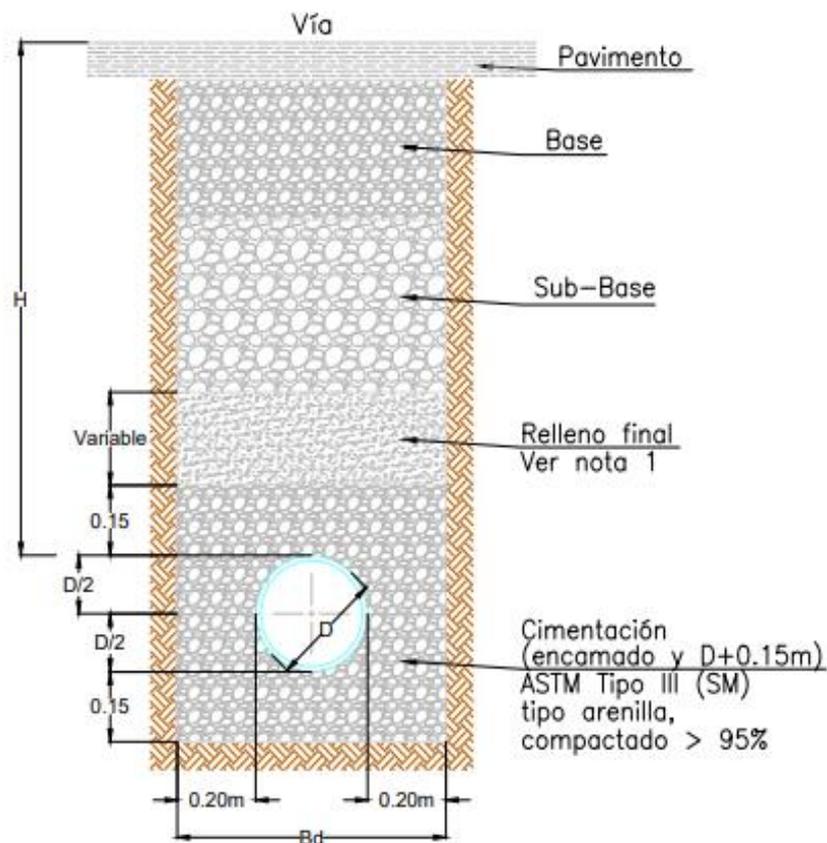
Detalle de tubería plástica para cimentación tipo E2.
